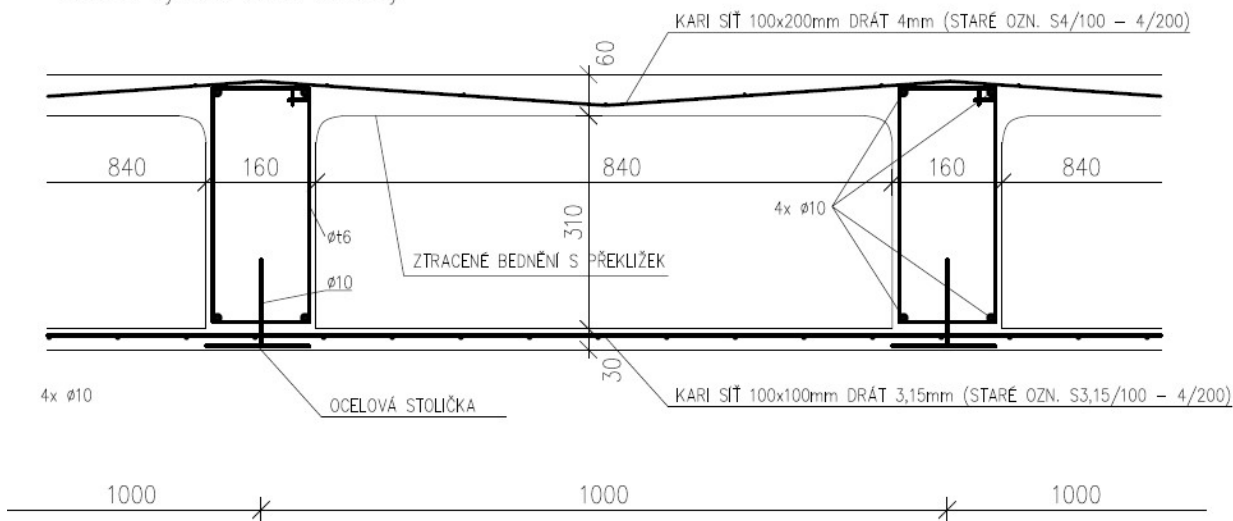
Schéma stropní konstrukce 1NP a 2 NP [17]
